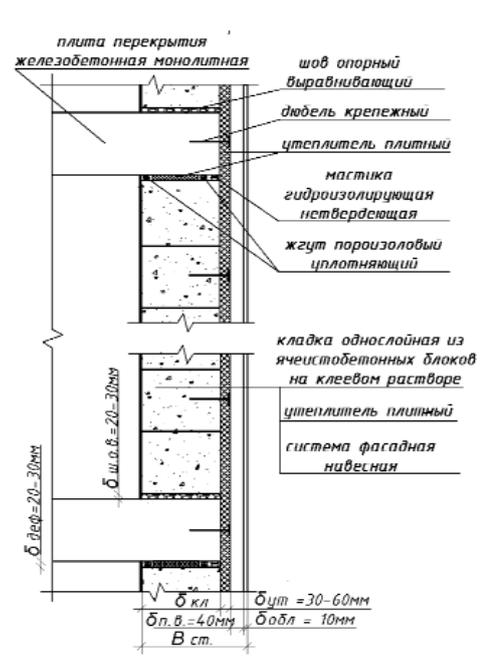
Стена двухслойная из ячеистобетонных блоков и плитного утеплителя с защитно-декоративной облицовкой
